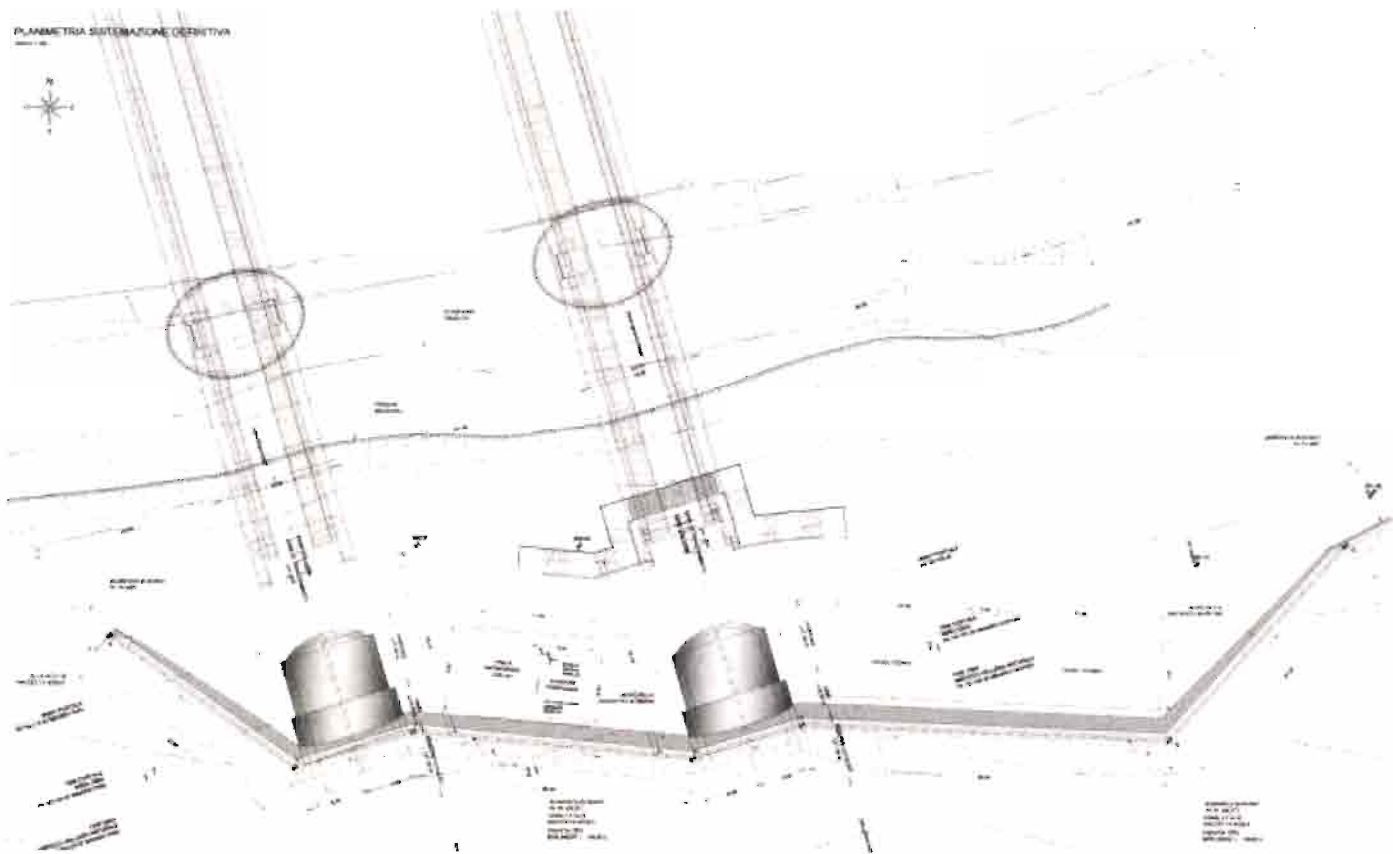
Grödner Tunnel Nord – Auszug Lageplan der Eingangsbauwerke.
